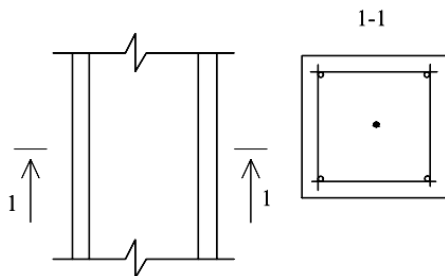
Трещины вдоль продольной арматуры в сжатых элементах
